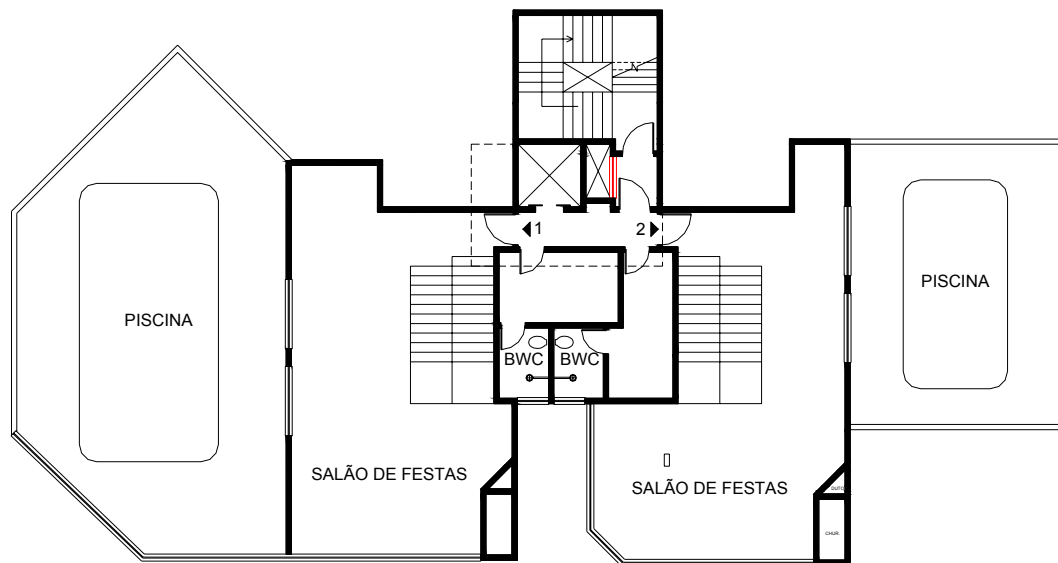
Planta Baixa do pavimento de cobertura do Estudo de caso C (Apartamento Triplex).
